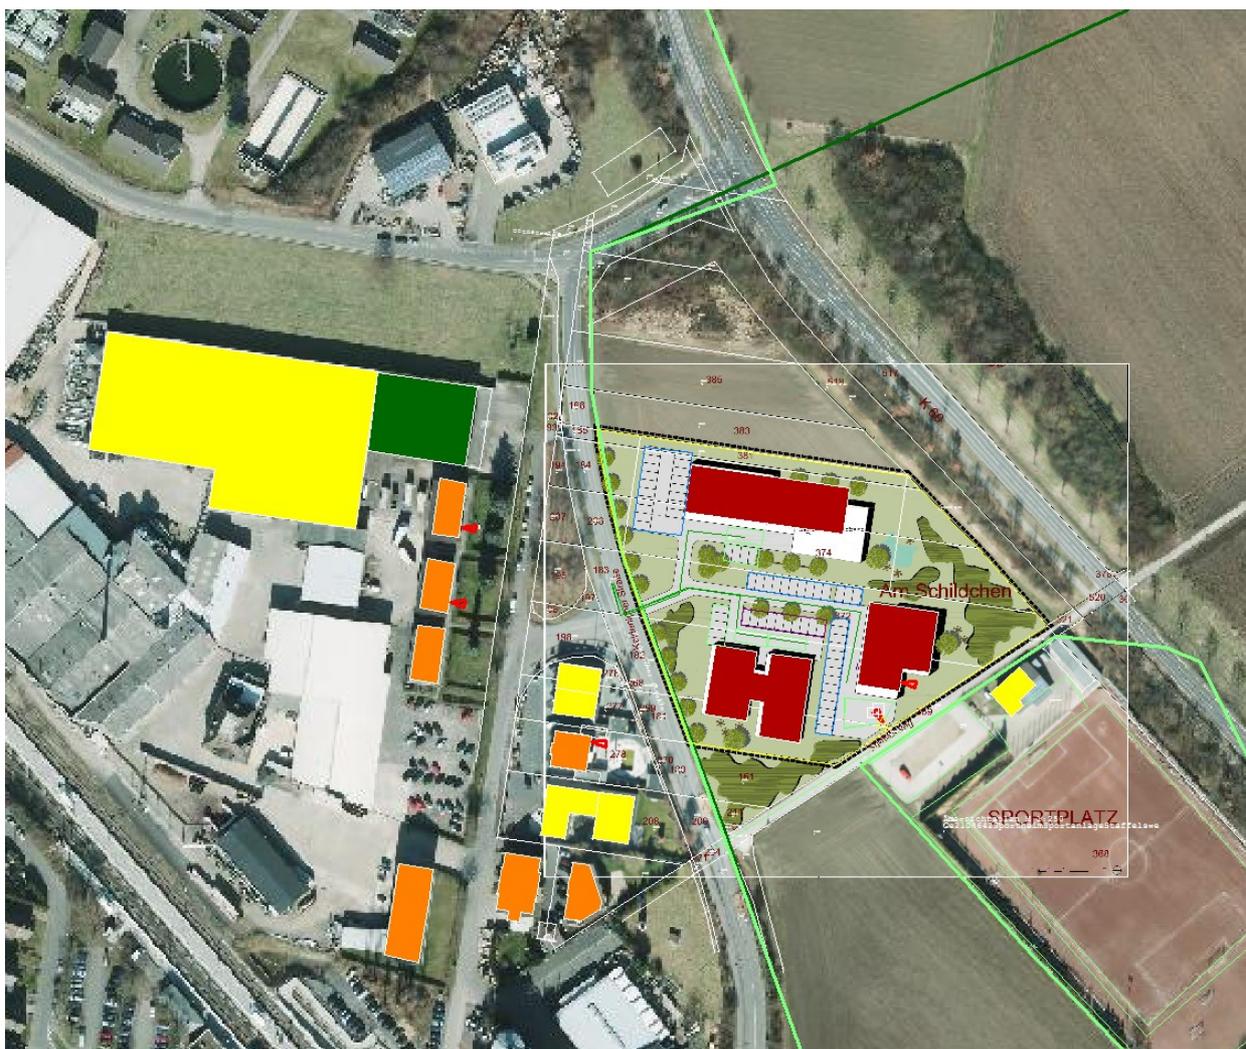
Lageplan mit angrenzender Bebauung sowie Schallquellen
